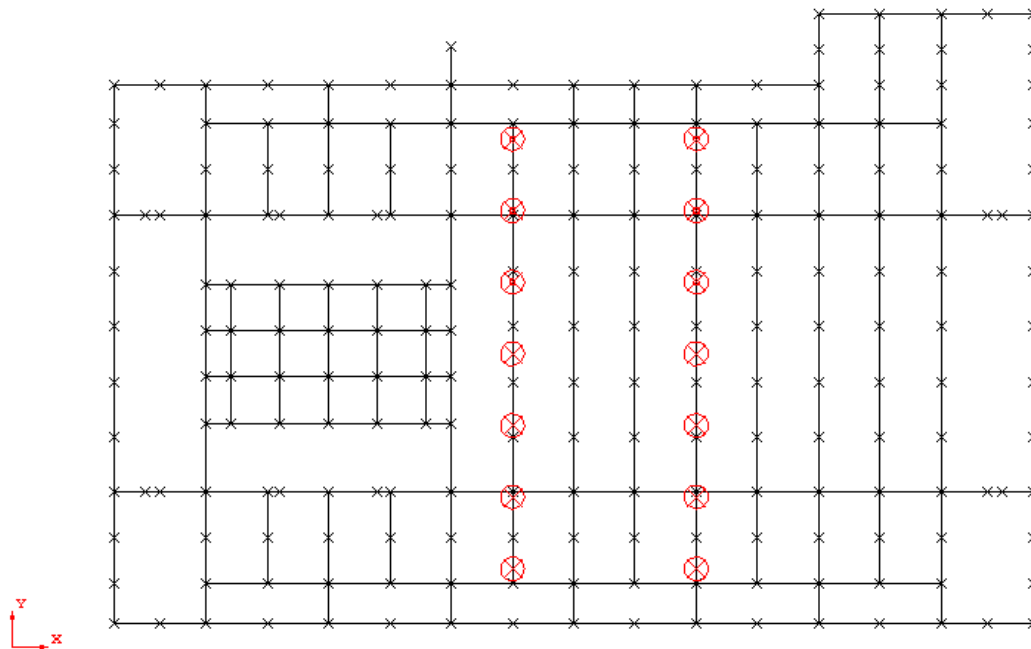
Grúa de pedestal sobre el paquete – Aplicación de cargas cubiertas superiores.
